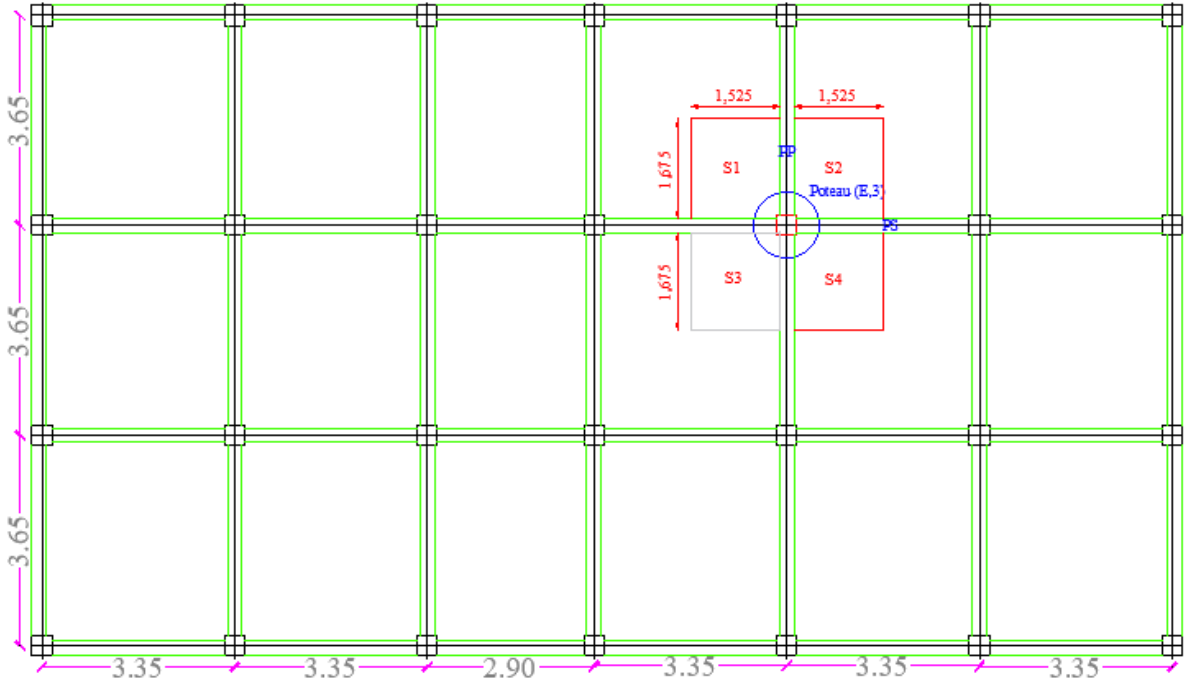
Position sur le plan du poteau le plus sollicité : axes (E, 3)
